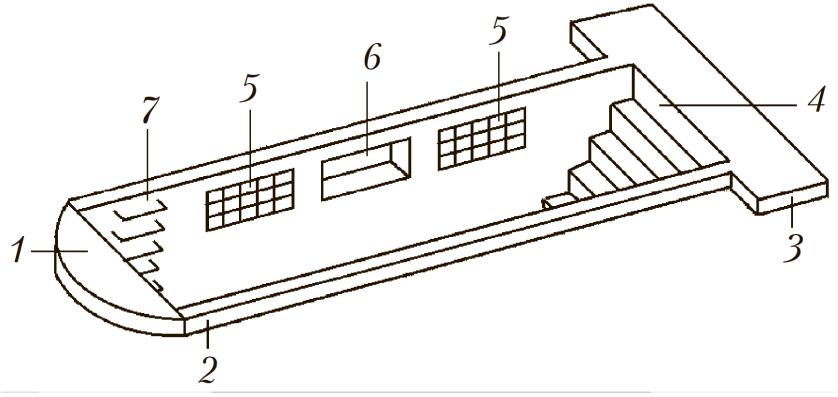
Схема межколейной изолированной канавы: 1 — отбойник; 2 — реборда; 3 — упор; 4 — лестница; 5 — ниши для светильников; 6 — ниша для инструмента; 7 — запасный выход
